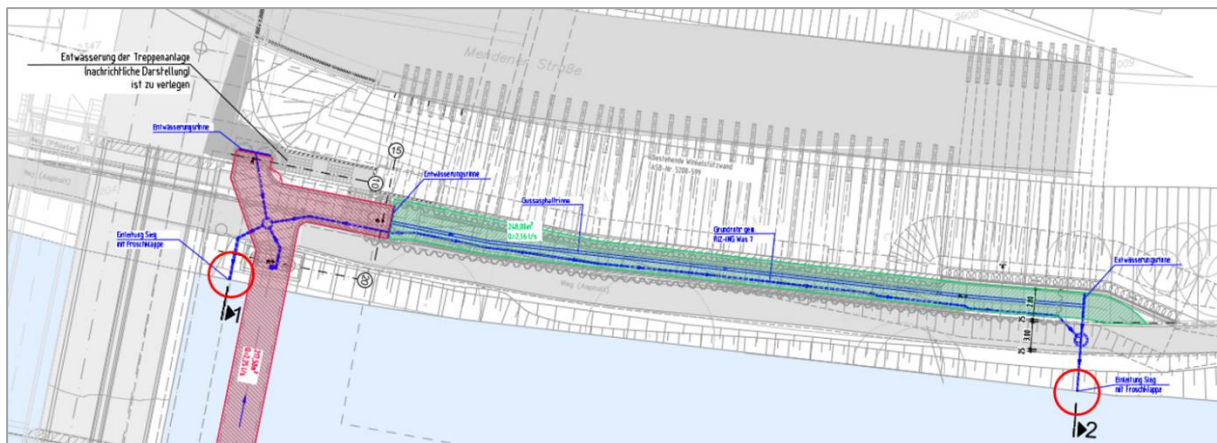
Entwässerung Brücke und Rampe in die Sieg mit Einleitstellen (roter Kreis), angepasst aus Genehmigungsplan zum Einleit Antrag: Entwässerung / Flächenplan Brücke und Rampe über die Sieg [7]
